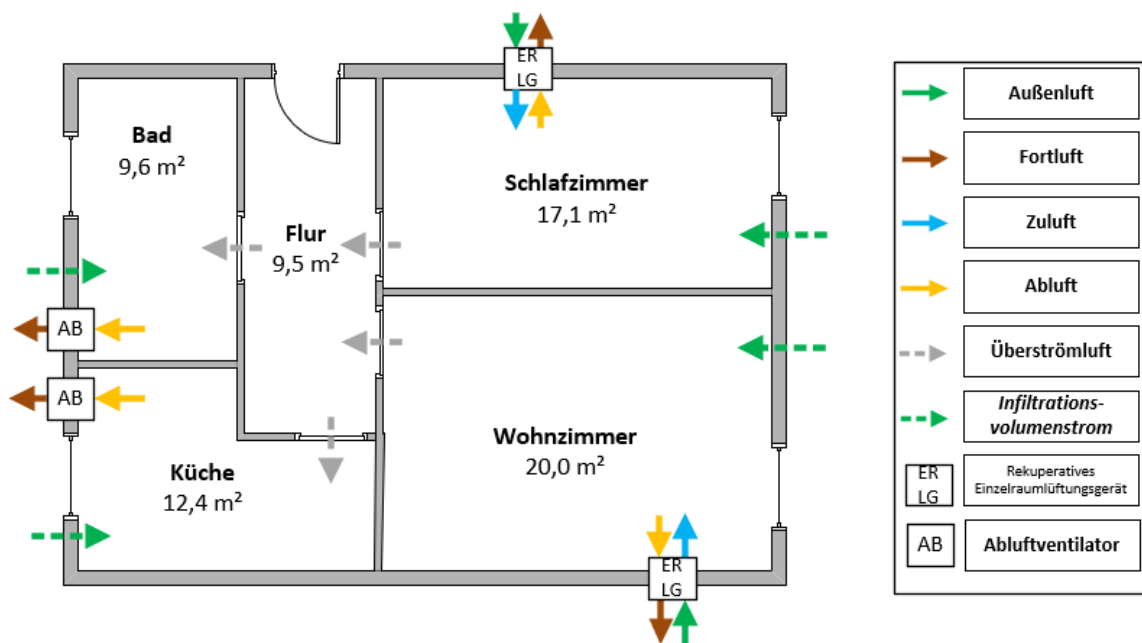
Grundriss Zwei-Zimmer-Wohnung, Schematische Darstellung reiner Luftströmung in den Zulufräumen, Abluftventilatoren in den Ablufträumen
